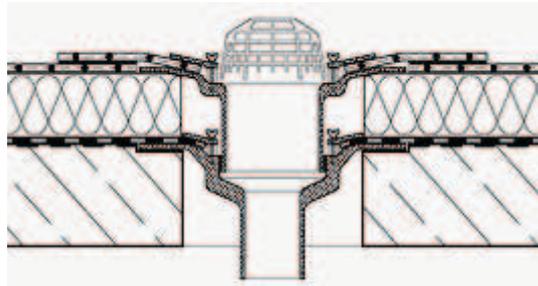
, Anschlussdetail bei einer Innenentwässerung
